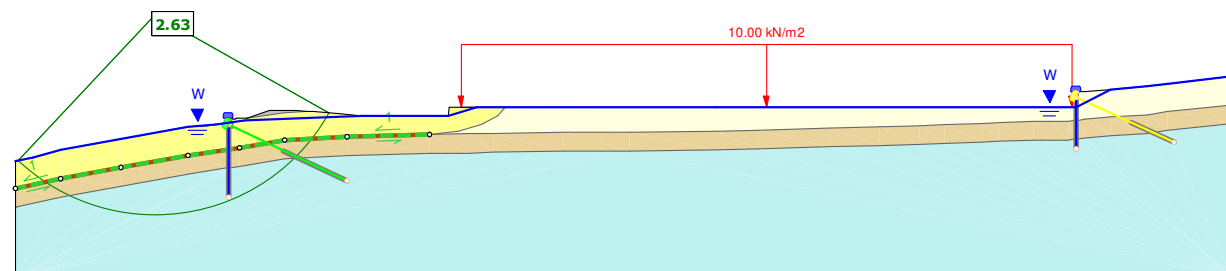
Sezione 1, caso 1e, stabilità presso la paratia di valle. Superficie di minima sicurezza.
